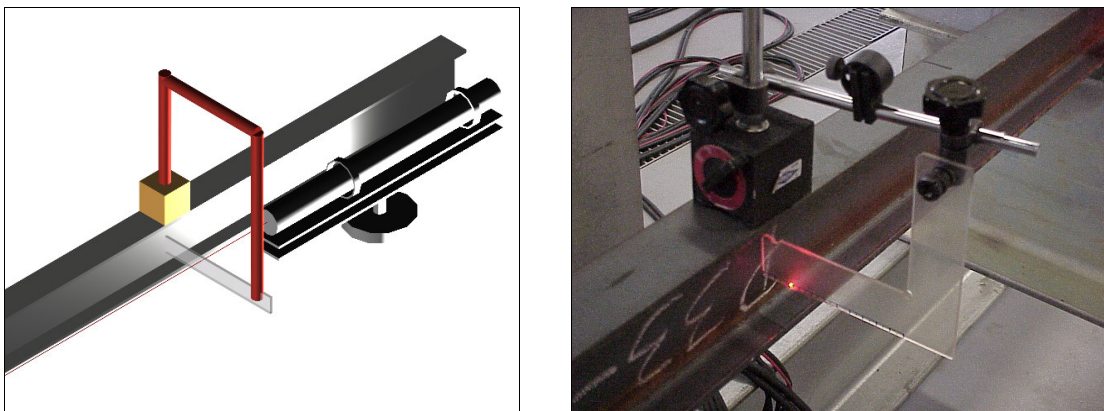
Montagem do equipamento auxiliar de medição.
